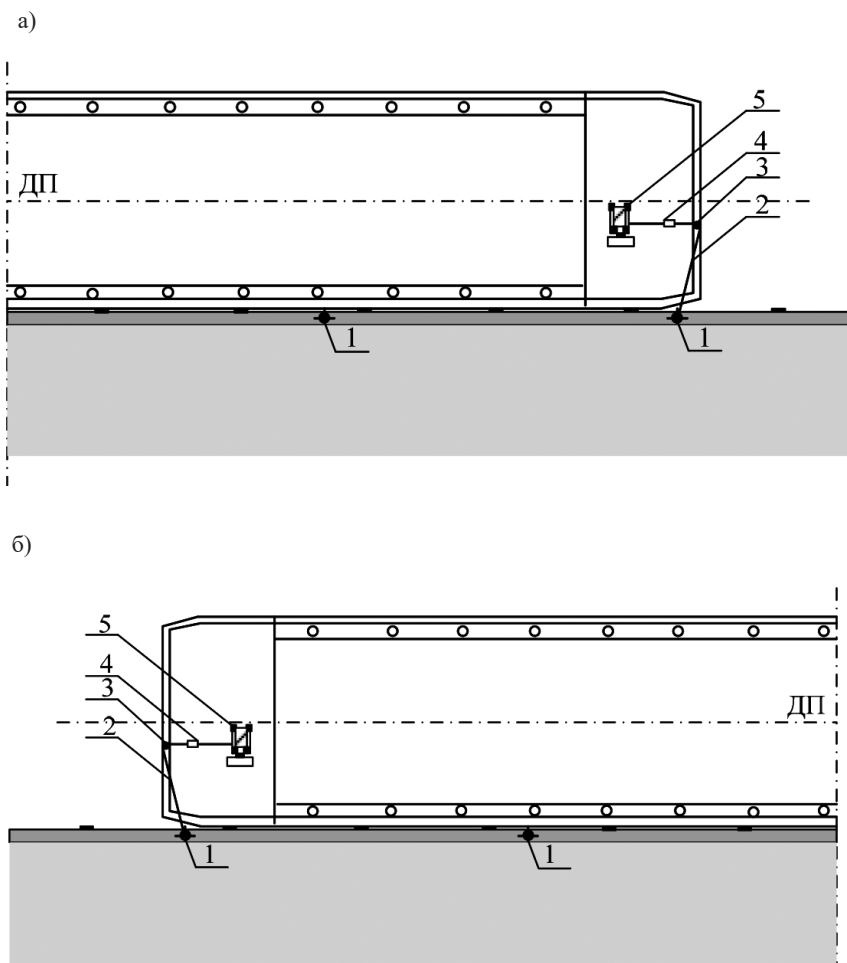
Схема натурной экспериментальной установки для проведения испытания швартовных тумб на расчетную нагрузку:
